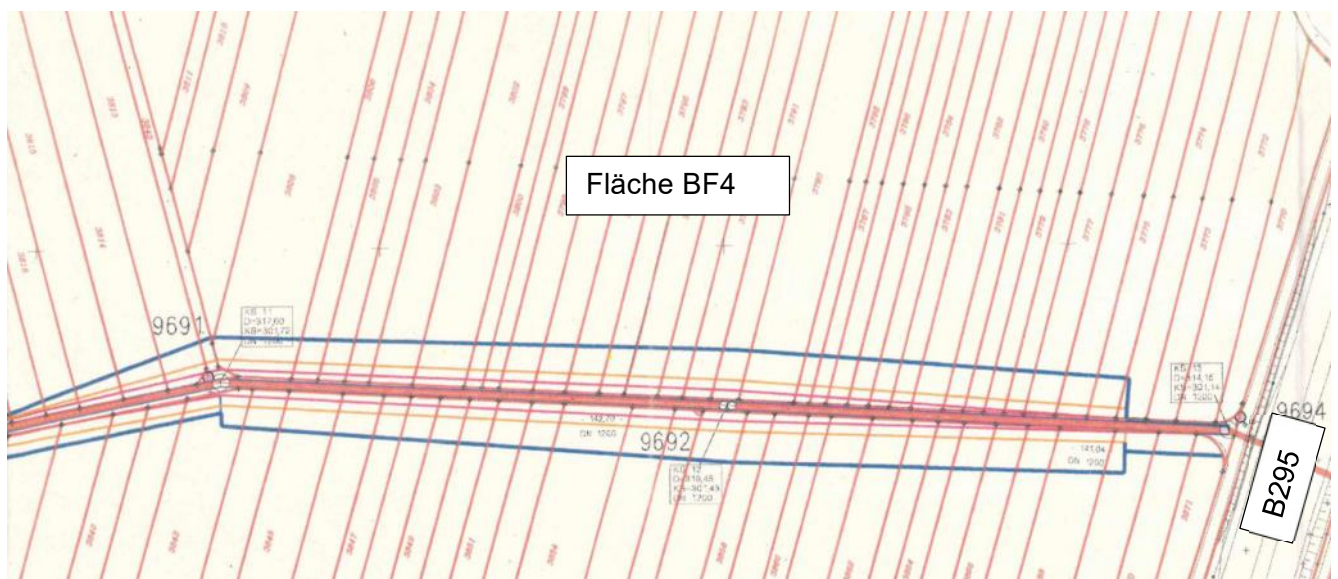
Ausschnitt Übersichtslageplan Hauptsammler [8], Flächeninanspruchnahme blau umrandet, unmaßstäblich
